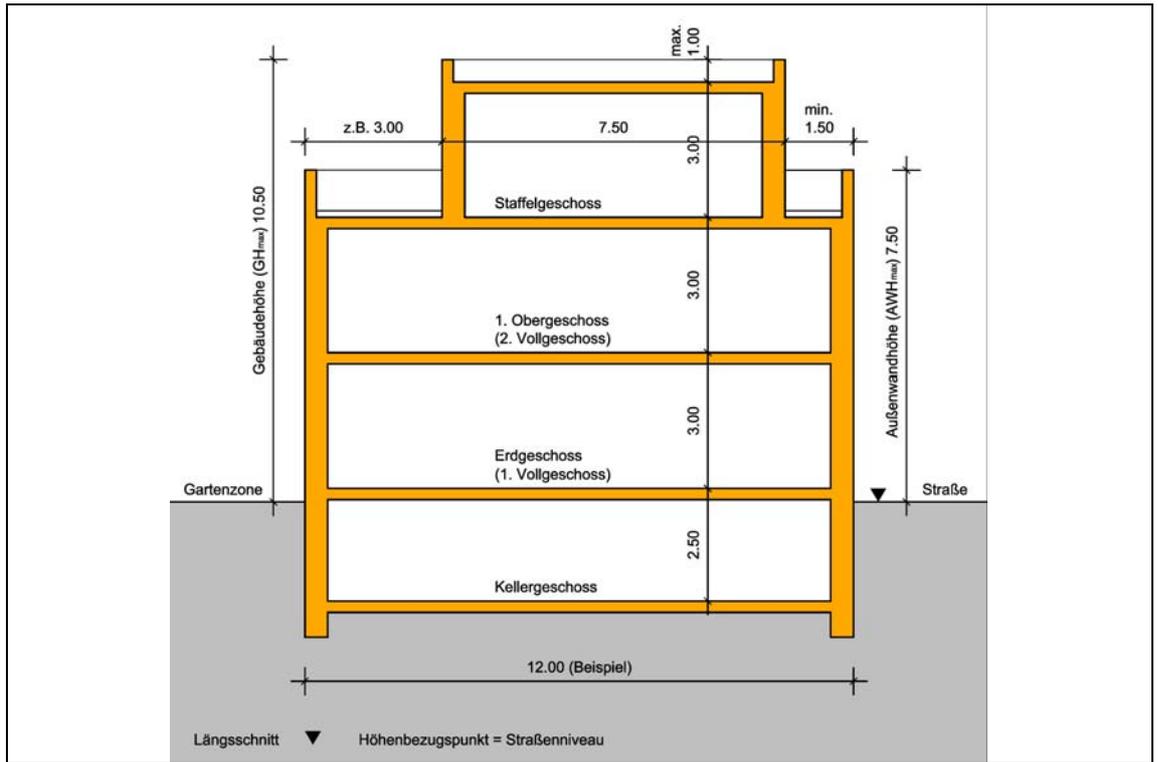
Schema-Längsschnitt zur Verdeutlichung der zulässigen Höhen bei Flachdach und zwei Vollgeschossen
